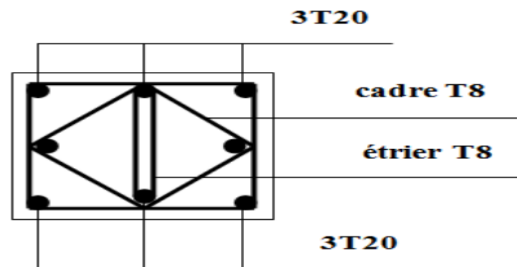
Schéma de ferrailage des poteaux coupe (E-E).
